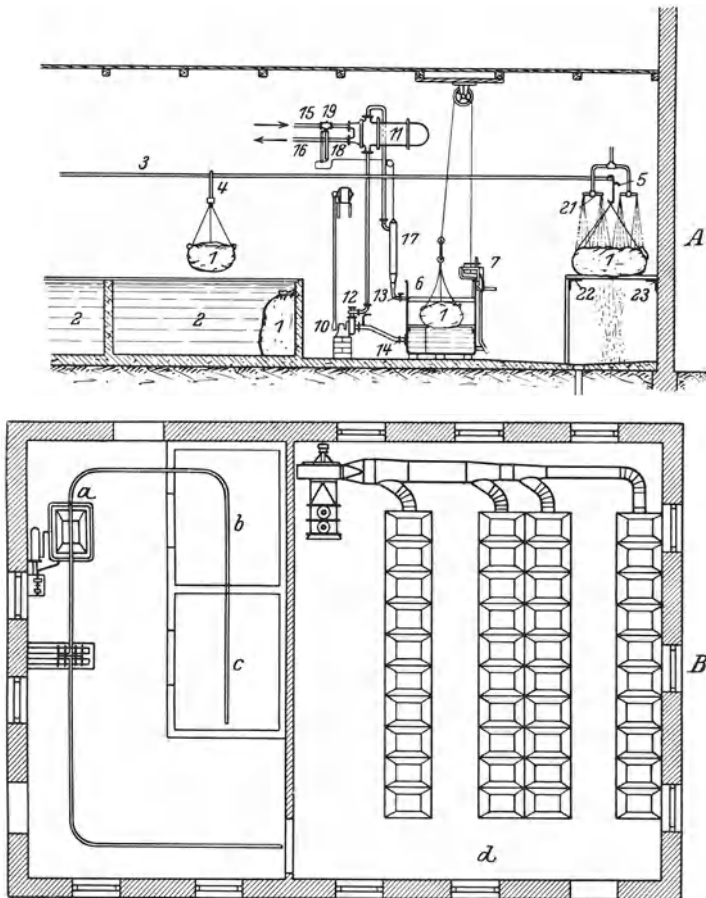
Beisanlage für Warmwasserbehandlung des Saatgetreides gegen Brand. (System DINESEN.) *A* Längs-schnitt; *B* Grundriß. *A*: 1 Sack; 2 Heizbehälter; 3 Rutschbahn; 4 und 5 Haken; 6 Warmwasserbehälter; 7 Winde; 10 Pumpe; 11 Vorwärmer; 12, 13 und 14 Ventile; 15 Dampfleitung; 16 Wasserleitung; 17 Regulier-behälter; 18 Thermostat; 19 Dampfventil; 21 Dusche; 22 und 23 Holzrost. *B*: *a* Vorwärmer; *b* und *c* Heiz-behälter, *d* Trockenraum.
